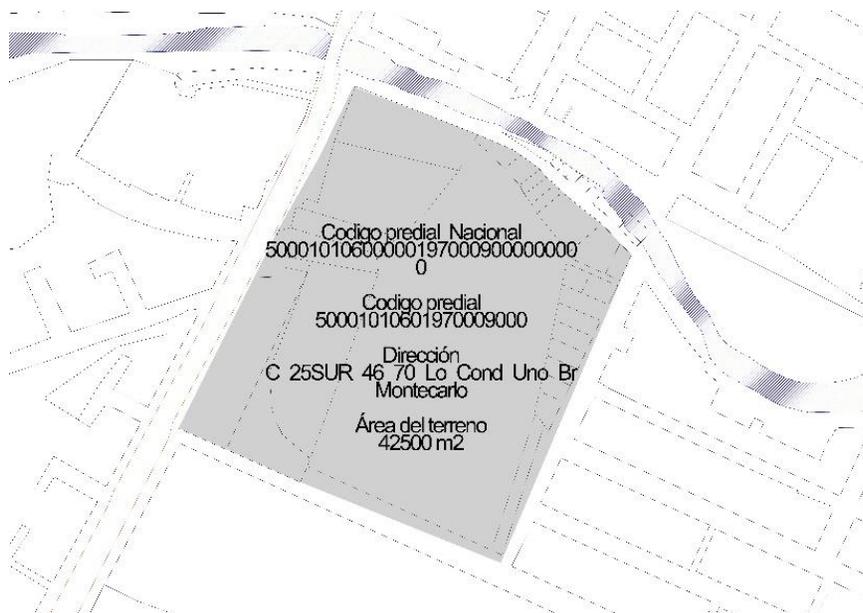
Área del predio. Planimetría. Fuente: Elaboración propia
